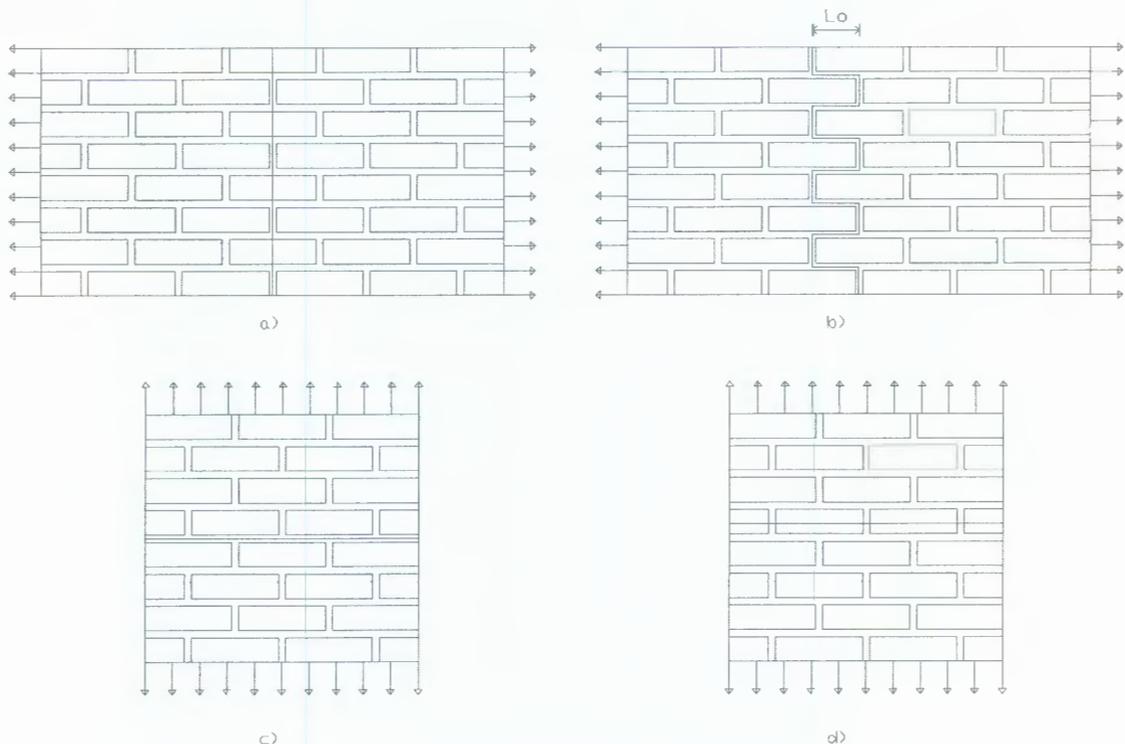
Modos de fallos de la mampostería sujeto a tensión directa
